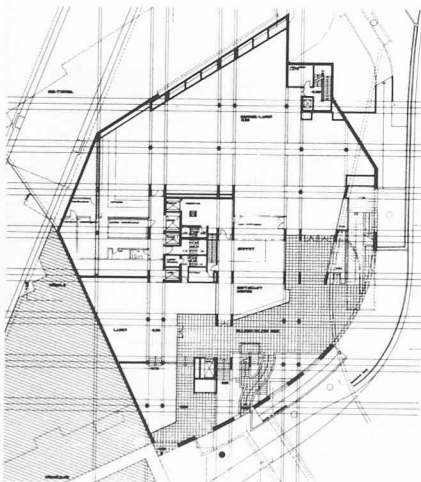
Falken. Rez sur la Falkenplatz et zone piétonne donnant sur la vieille ville.
